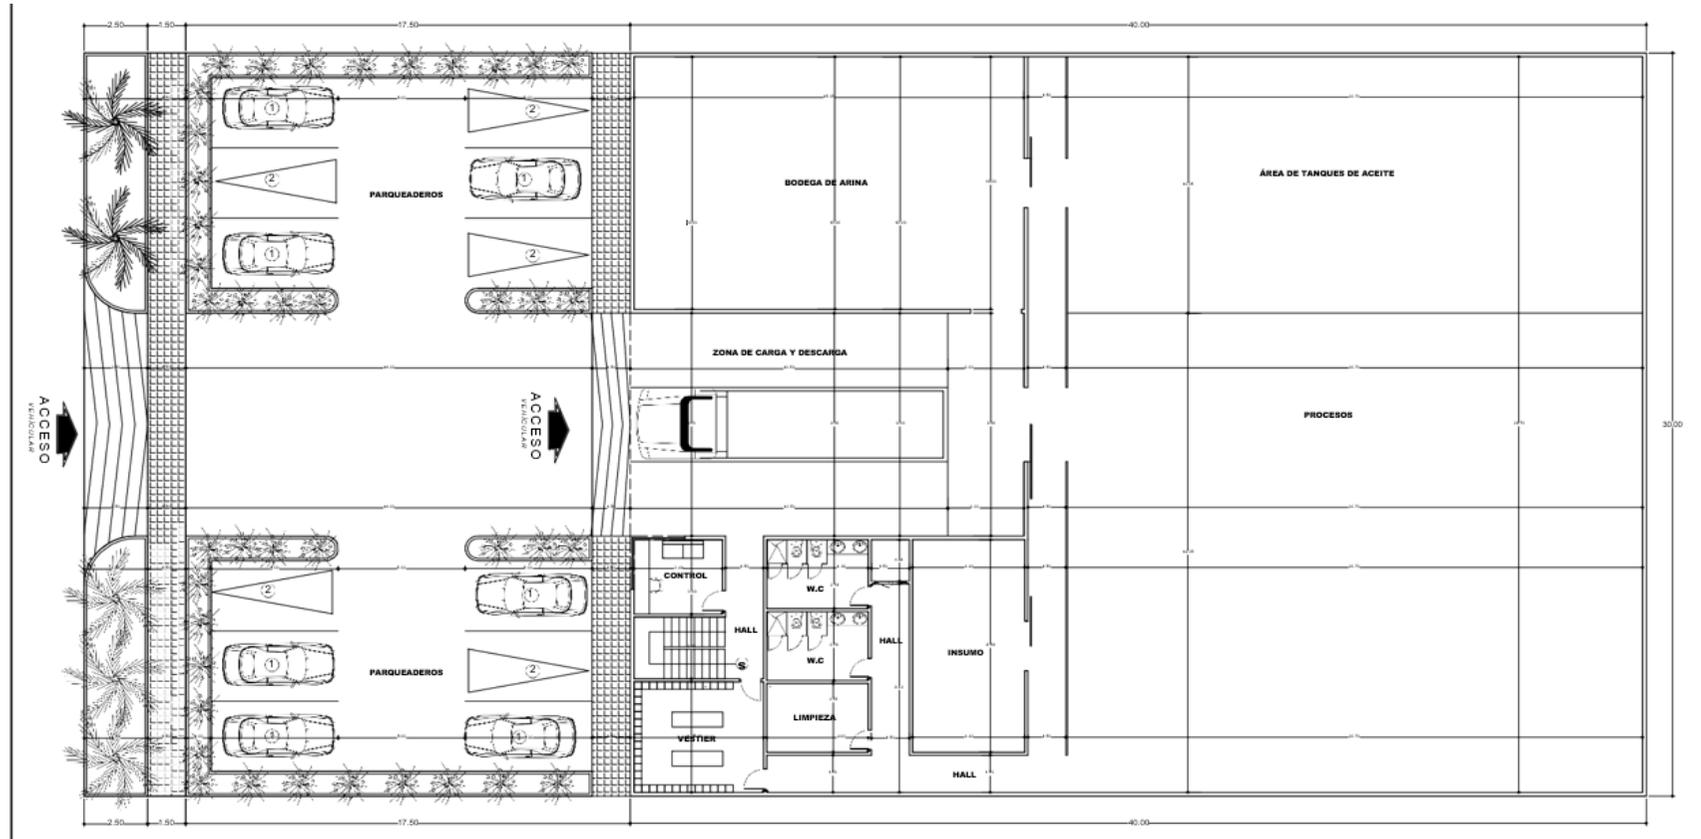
Plano del primer piso planta de harina y aceite de pescado PEZHYA.
